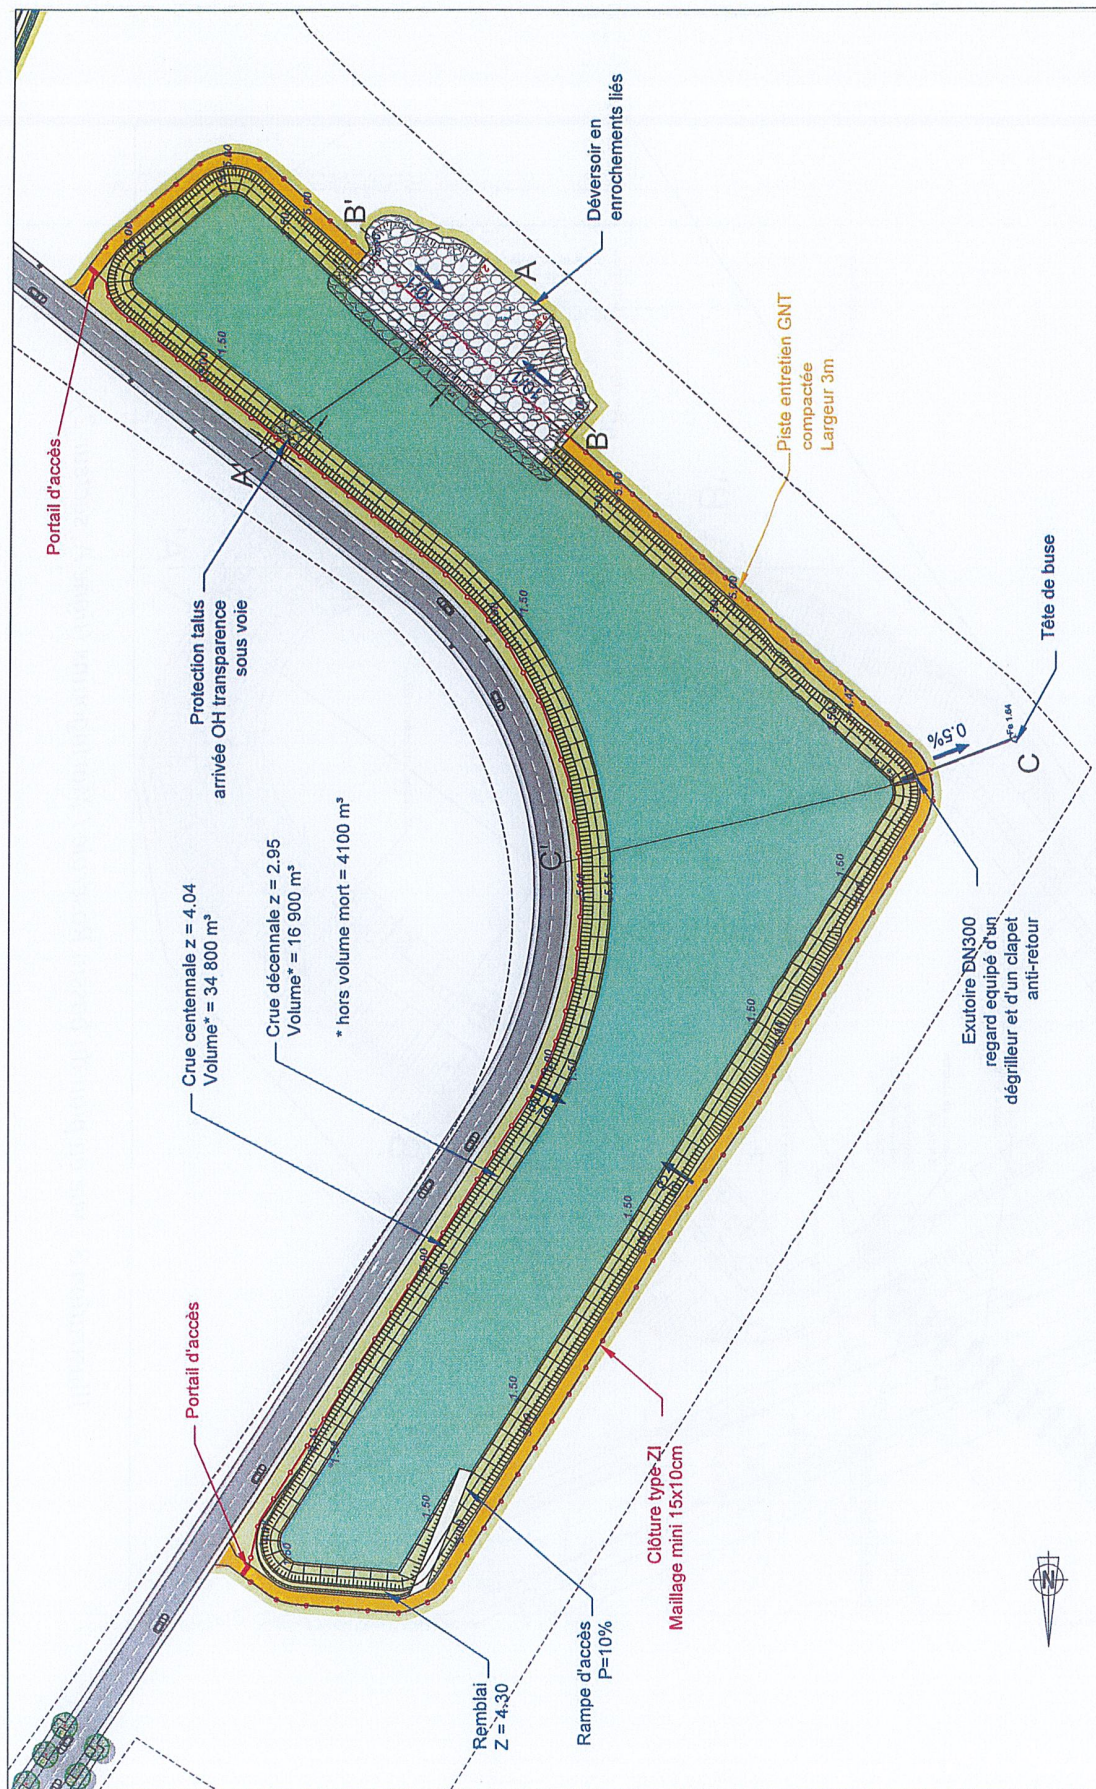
vue en plan du bassin de Montabo (ligne B, secteur 12)
